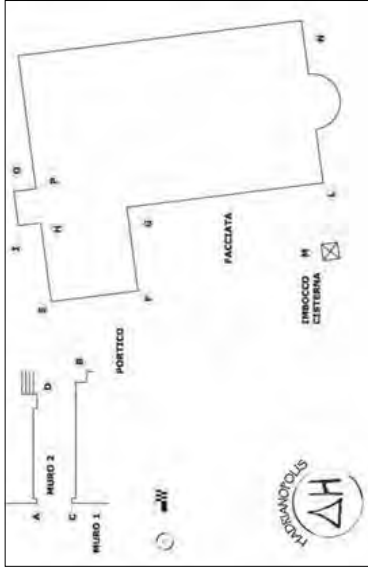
Spile, schizzo planimetrico del sito del monastero.
